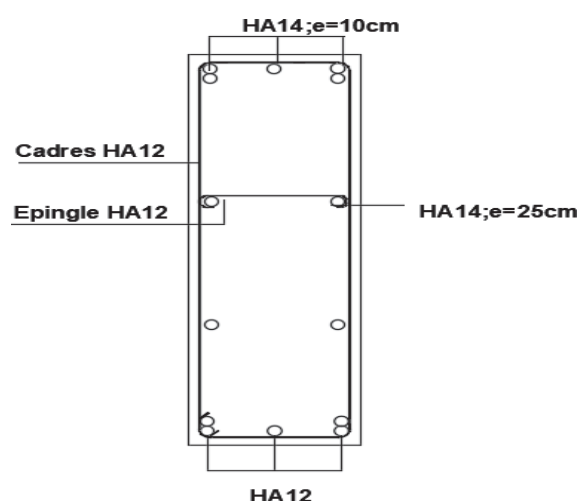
Croquis de ferrailage de l'entretoise.
